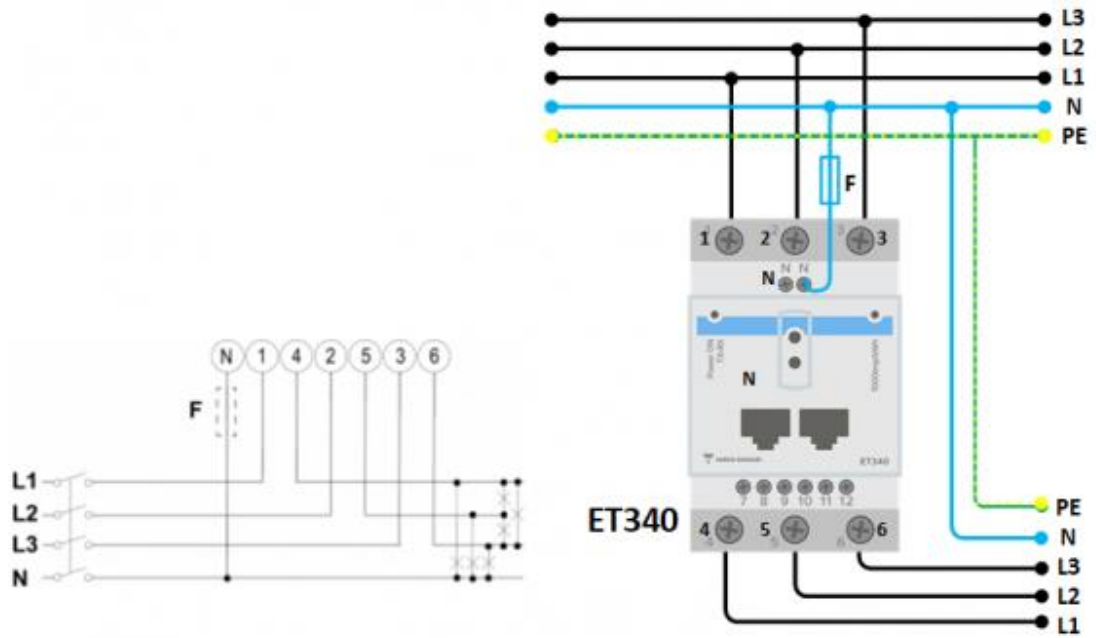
Anschlussplan Carlo Gavazzi ET340
